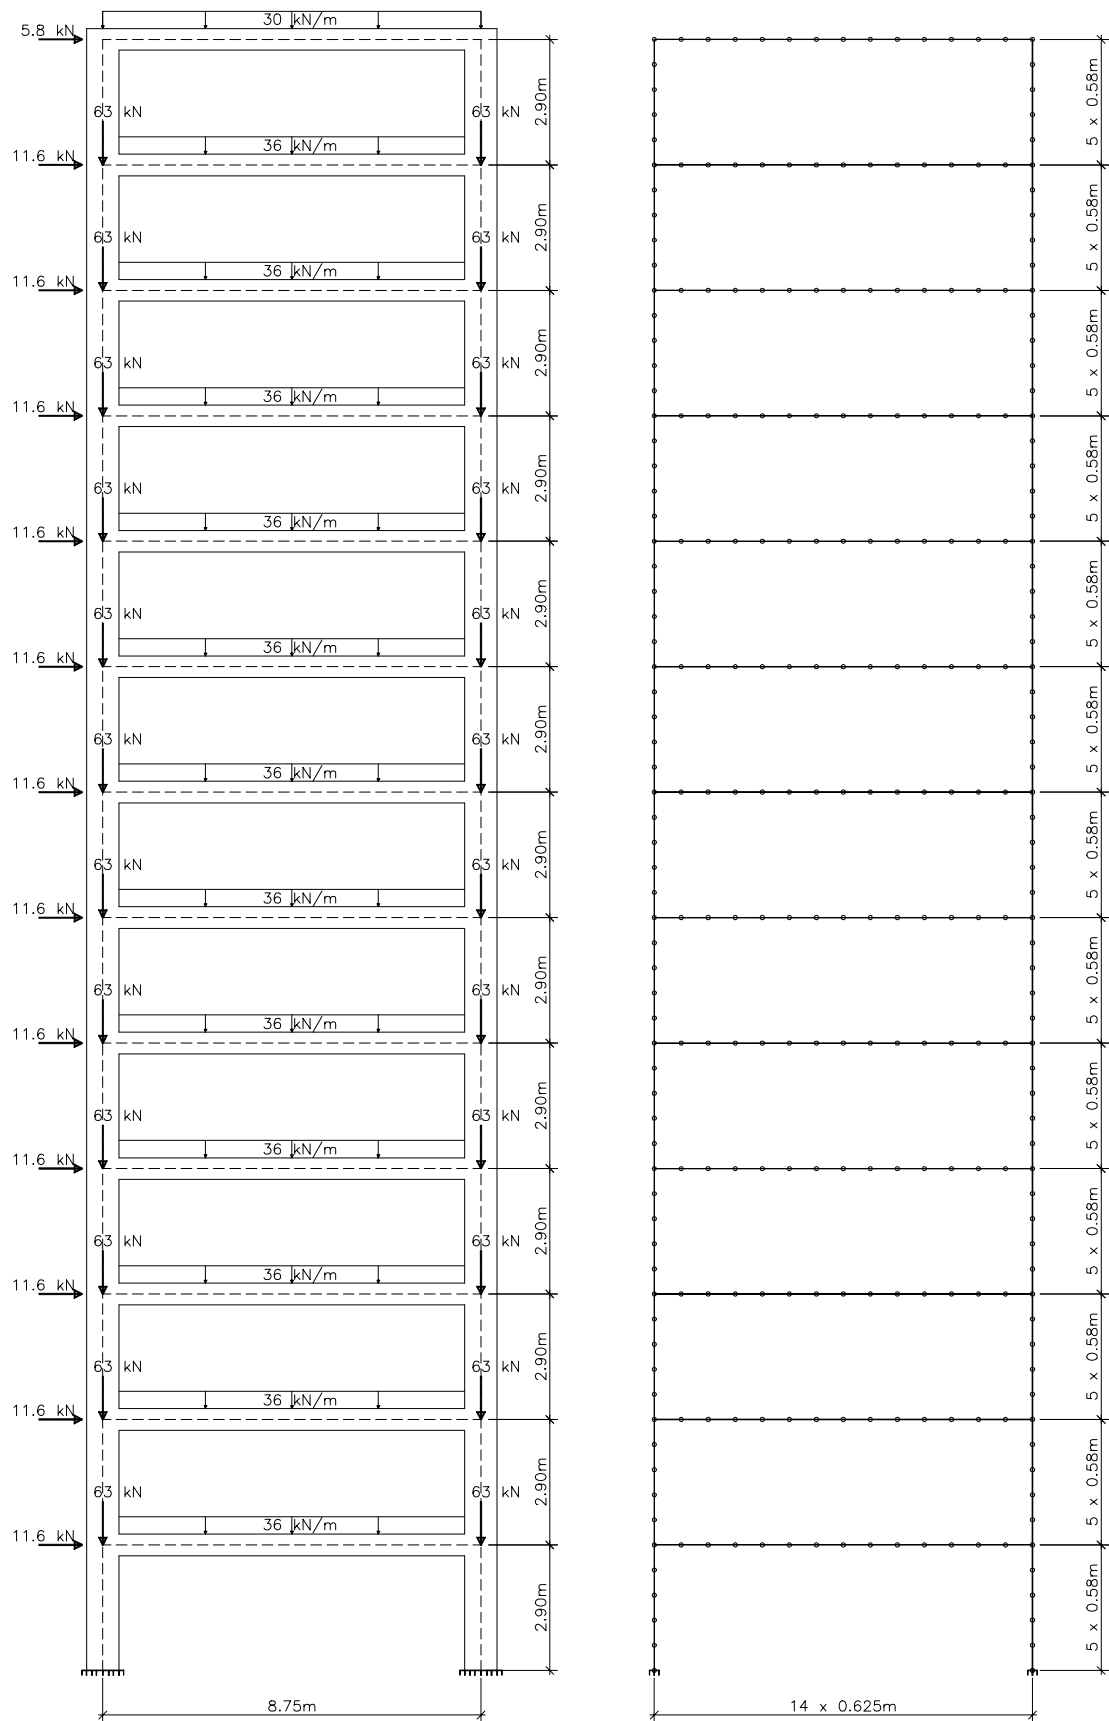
Geometria e discretização do pórtico pertencente ao edifício 13 pavimentos
